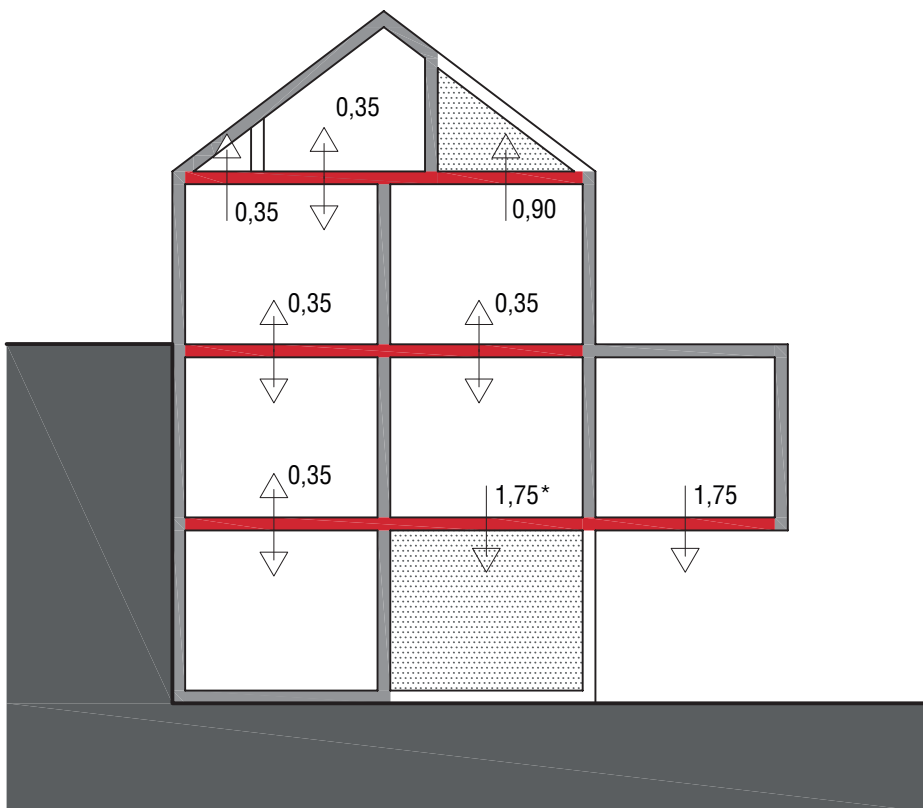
Mindestwärmedurchlasswiderstände nach DIN 4108-2: Decken
